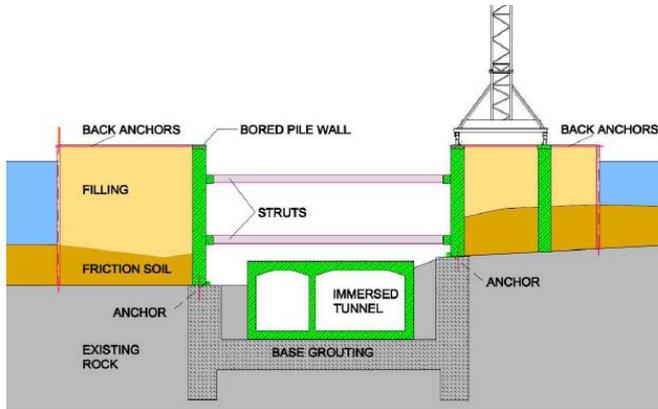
Baugrube mit abgesenktem Tunnel<sup>5</sup>
